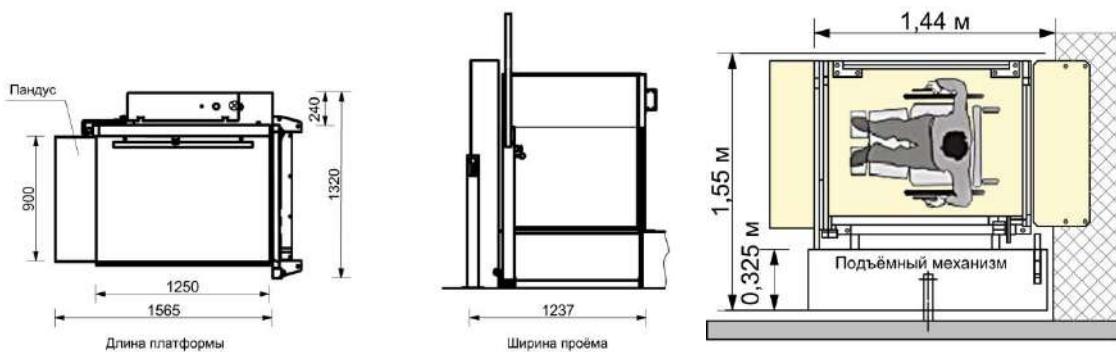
Стандартные габариты платформы с вертикальным перемещением
